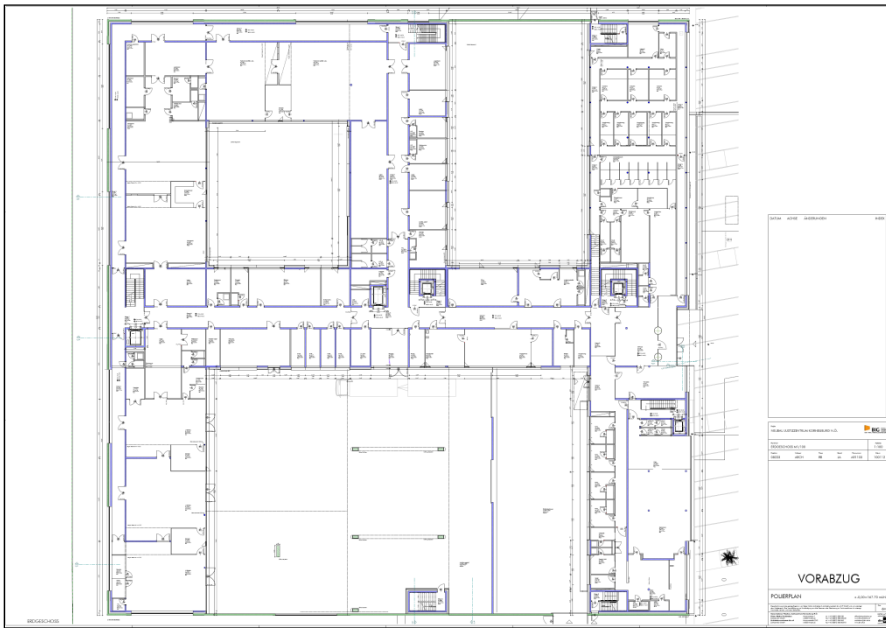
Erdgeschoss Grundriss – Justizanstalt⁵³¹
